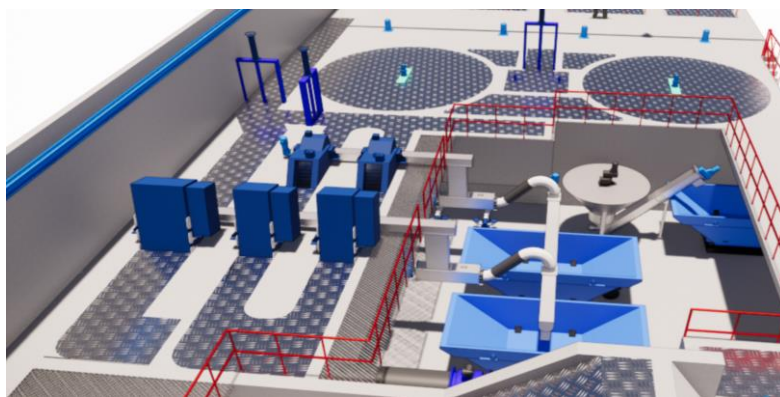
Vue 3D du dégrillage grossier et fin.
